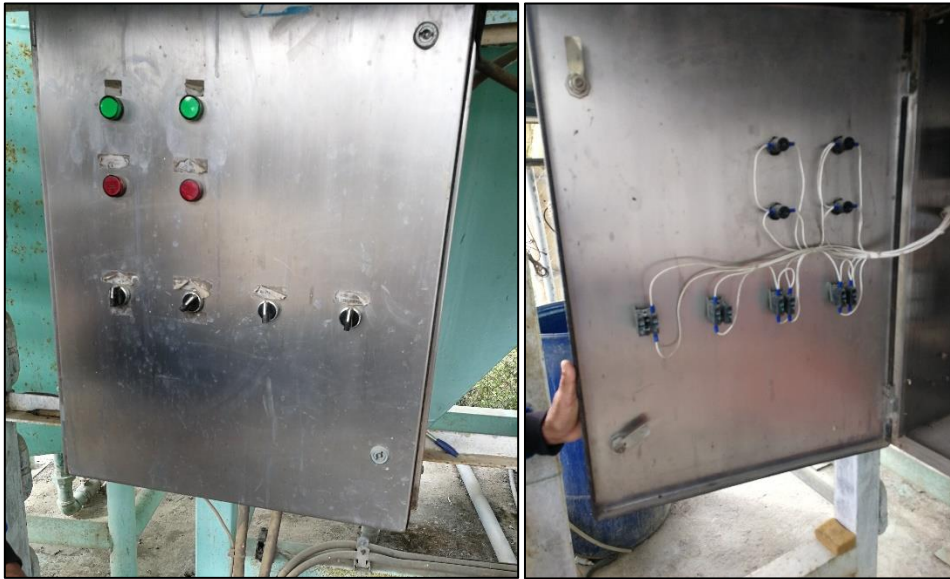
Sistema eléctrico de la planta potabilizadora.
